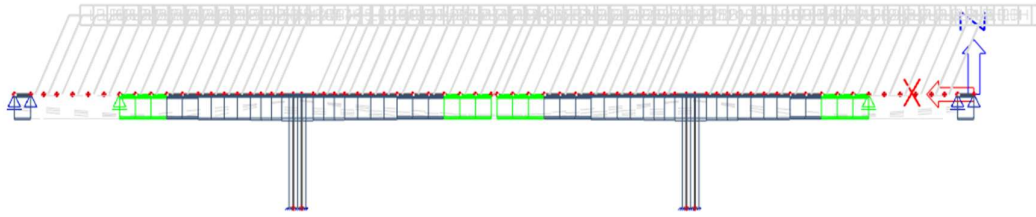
Detail na pilířovou oblast ve fázi výstavby 4
